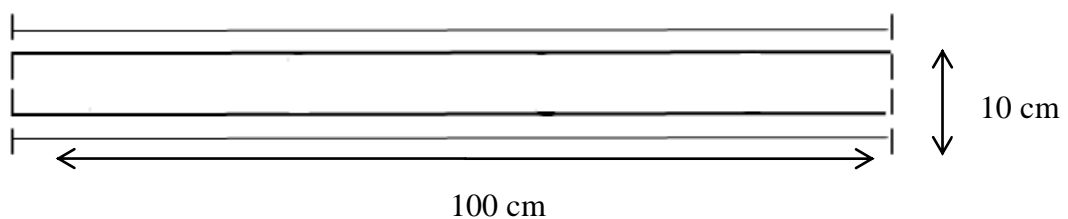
Section théorique pour le ferrailage de l'acrotère.
